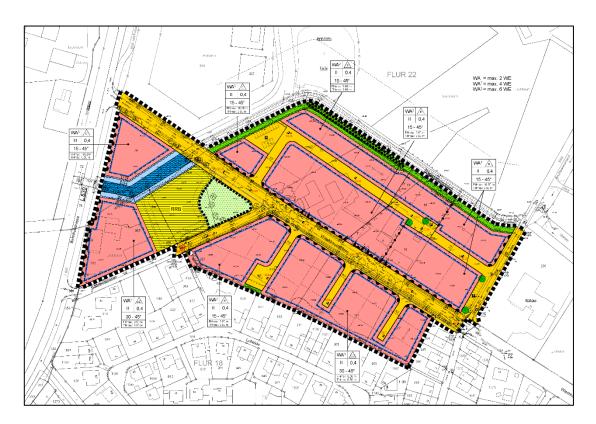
Bebauungsplan mit Lage des Plangebietes
